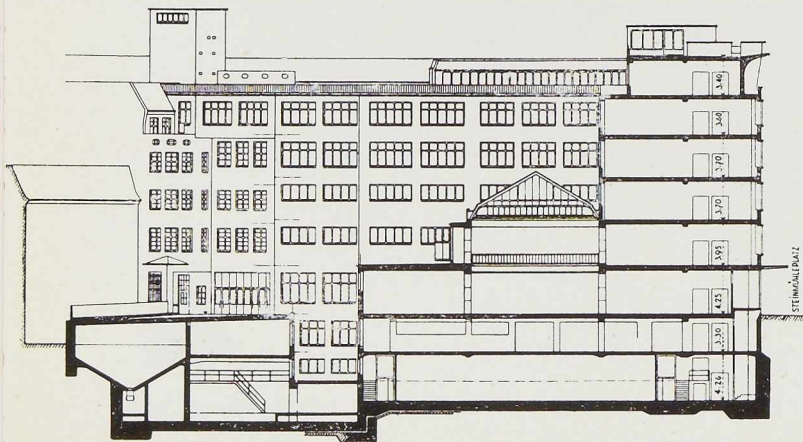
Coupe à travers le bâtiment à l'endroit de l'entrée principale.
